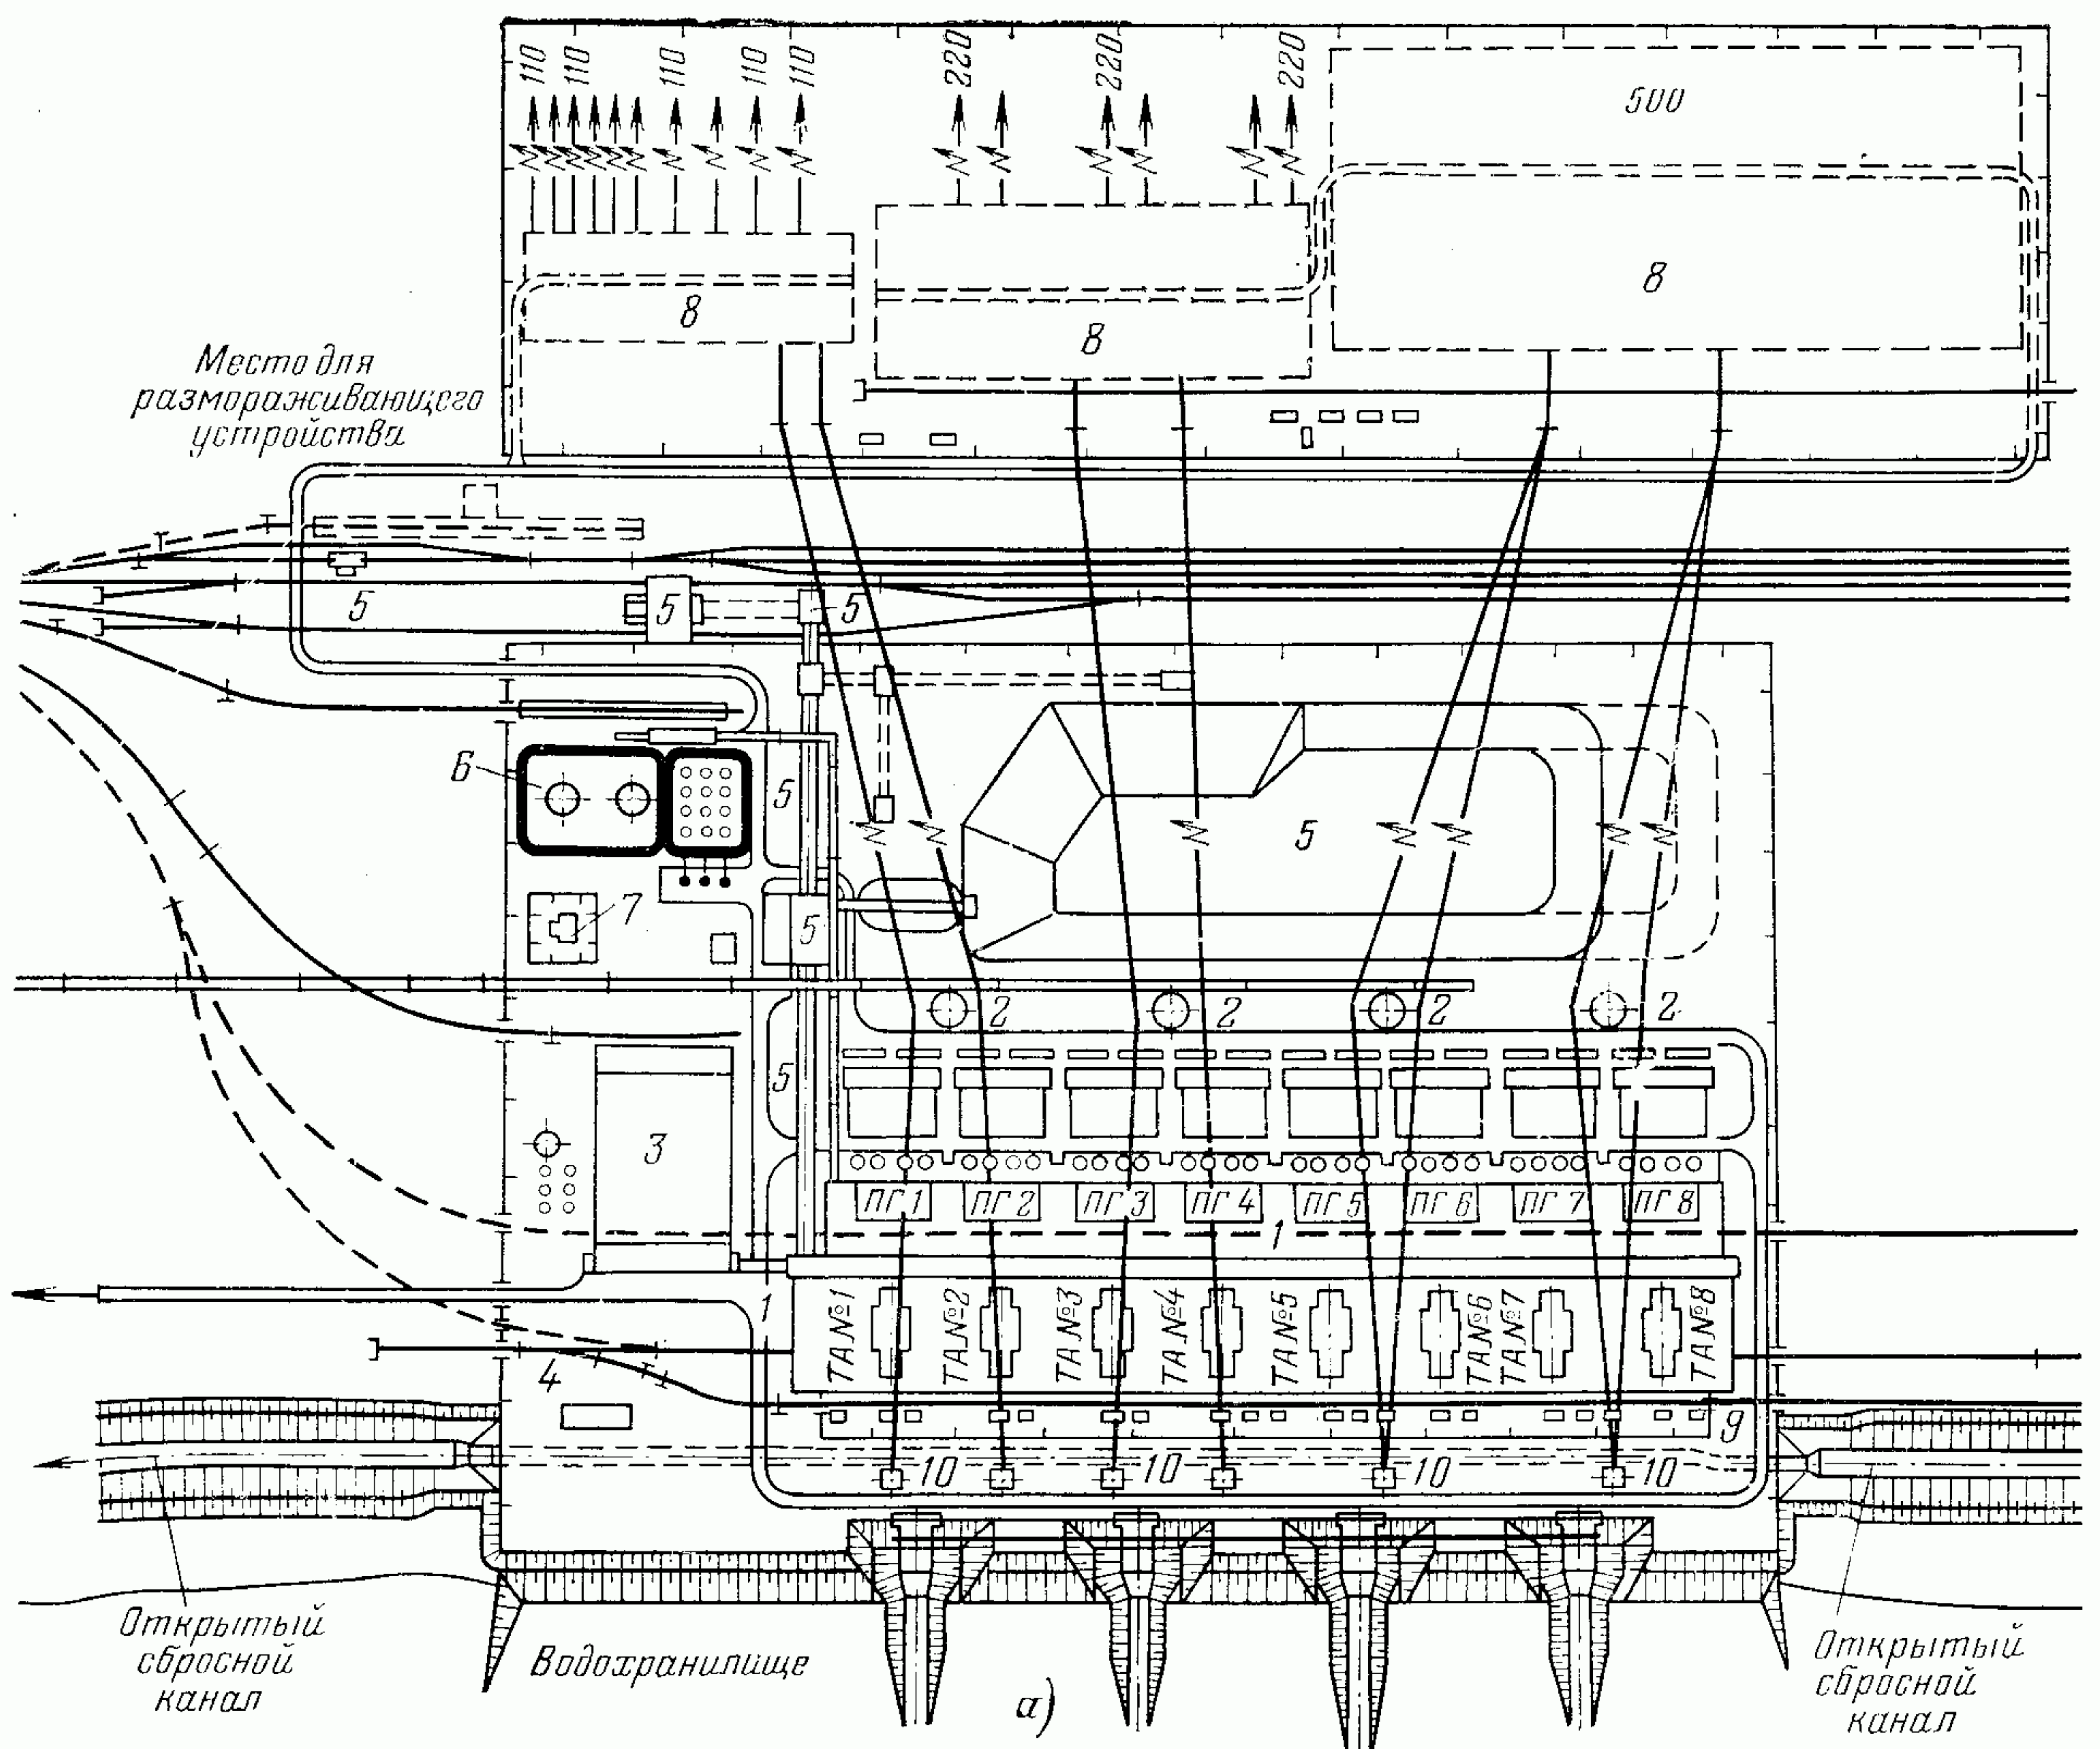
Генплан пылеугольной электростанции 2400 МВт с размещением ОРУ за угольным складом.
